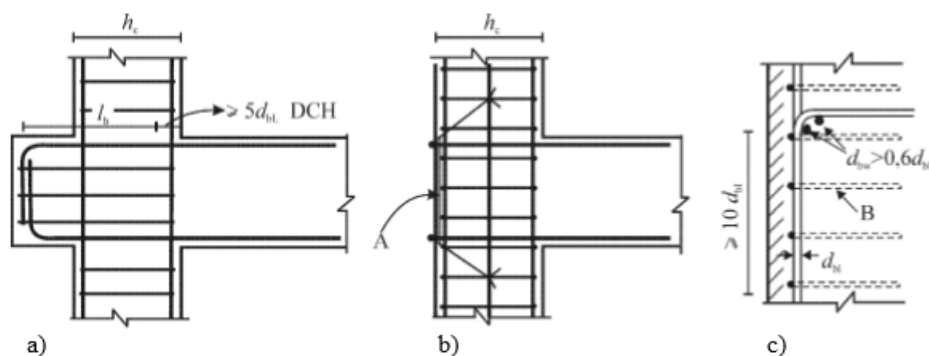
Disposições alternativas de amarração viga-pilar exterior (*Eurocódigo 8*)
